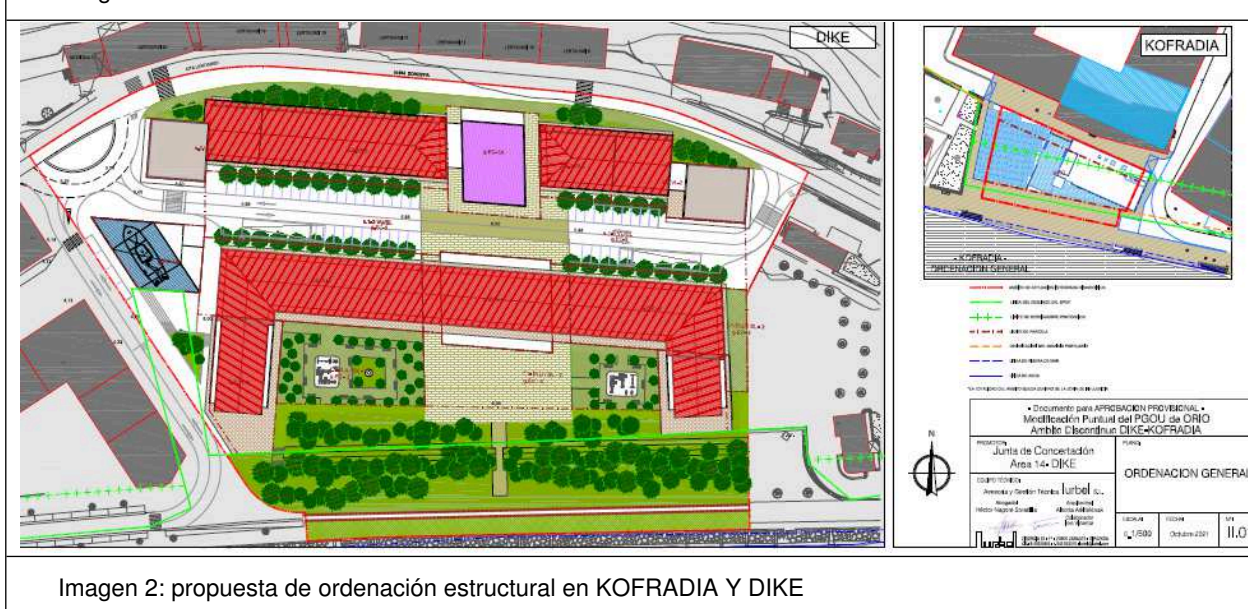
propuesta de ordenación estructural en KOFRADIA Y DIKE
